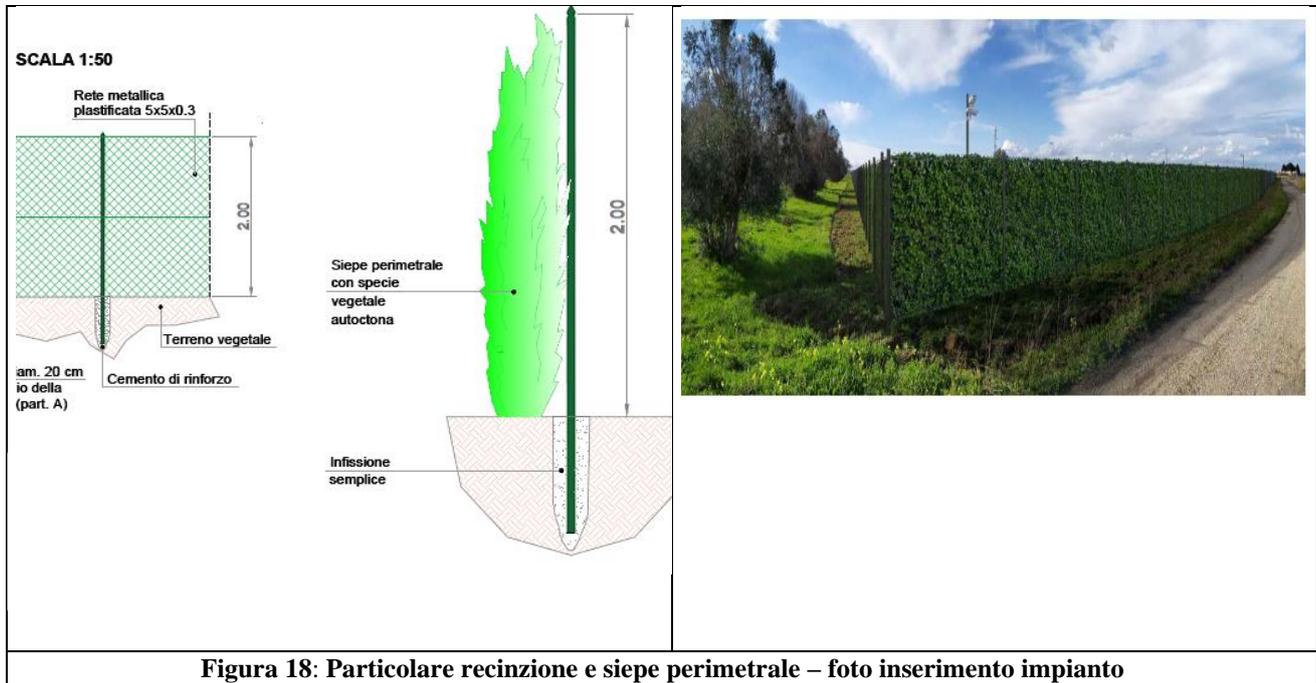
Particolare recinzione e siepe perimetrale – foto inserimento impianto
